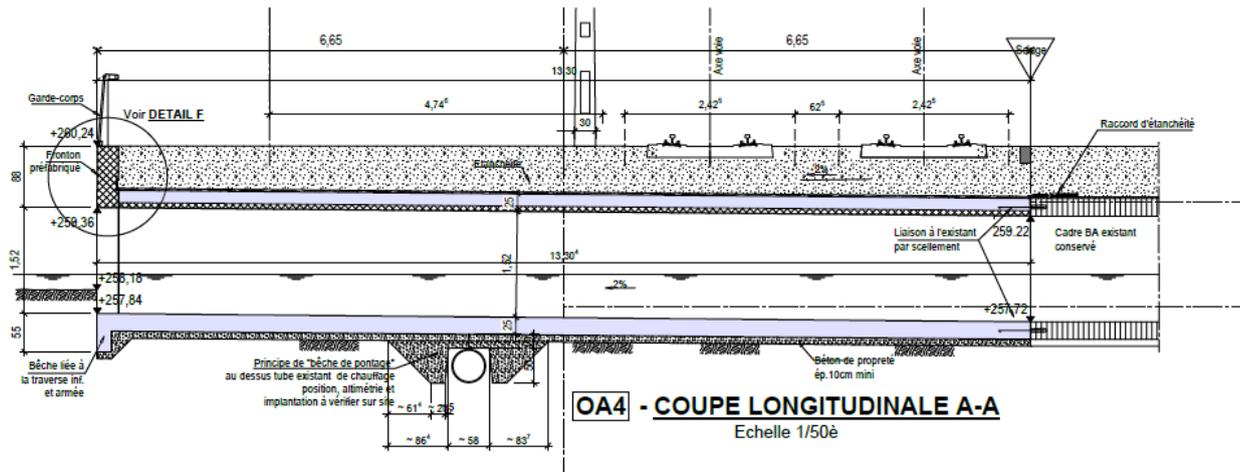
Coupe longitudinale de l'OA Lertzbach au droit du boulevard de l'Europe (Uniquement la partie réalisée dans le cadre des travaux du tram) (Source : Tertio, 2017)
